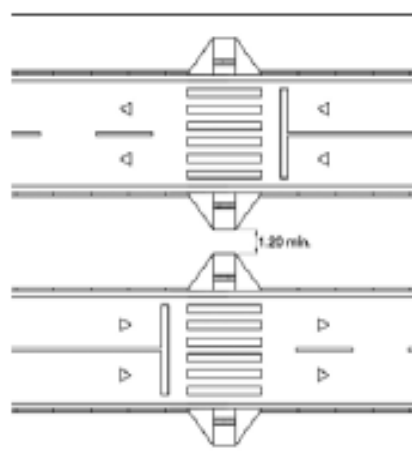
Canteiro divisor de pistas - Exemplo 1
